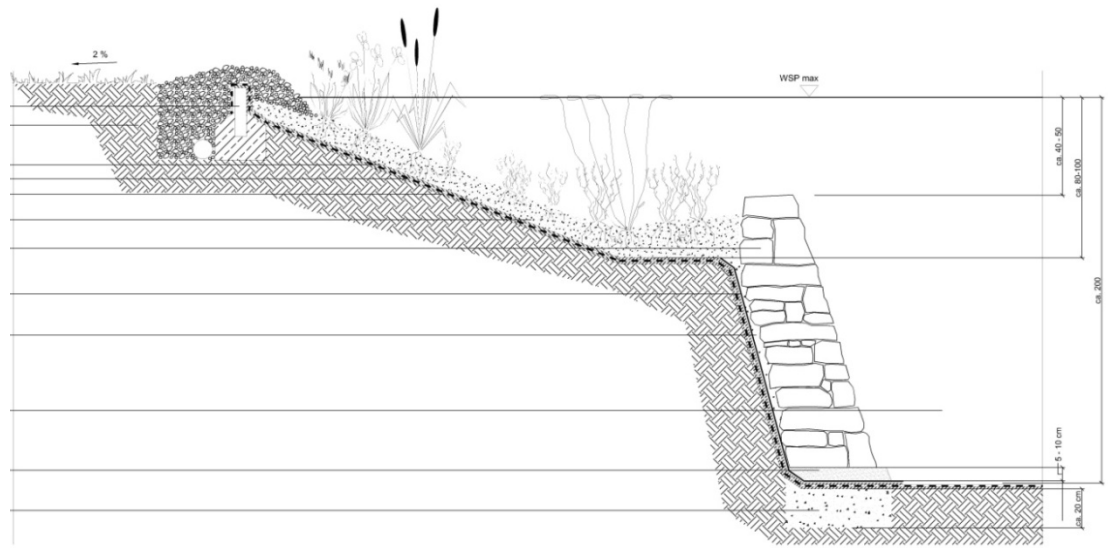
Plavecké jezírko zemní se zdí stavěnou nasucho
